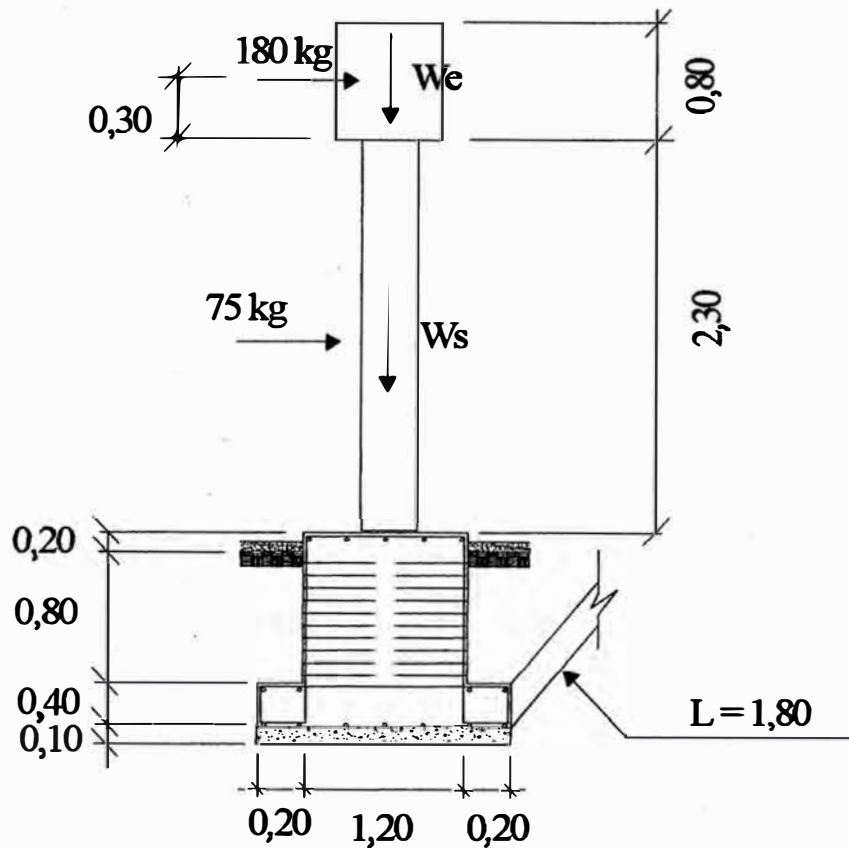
Vista de corte de la Base de cimentación del recloser
